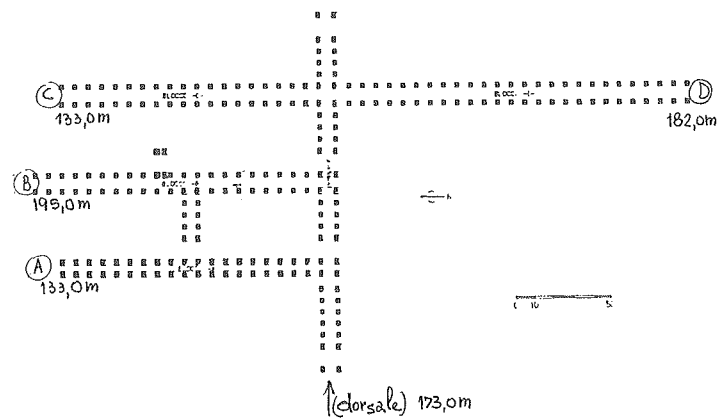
Pianta generale delle fondazioni del Pipe-rack.
